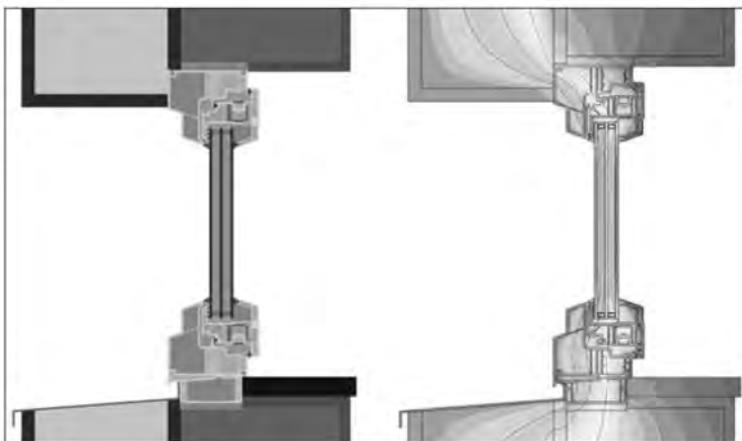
Anschlussdetail Fenster nach 1. Sanierungsschritt
